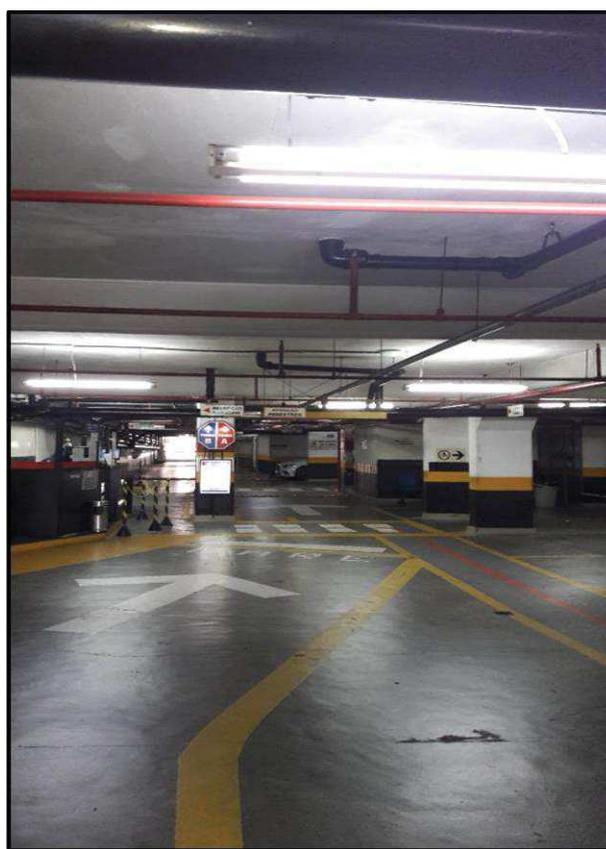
Vista porta de emergência p/ escada externa Foto 09- Administradora do estacionamento
